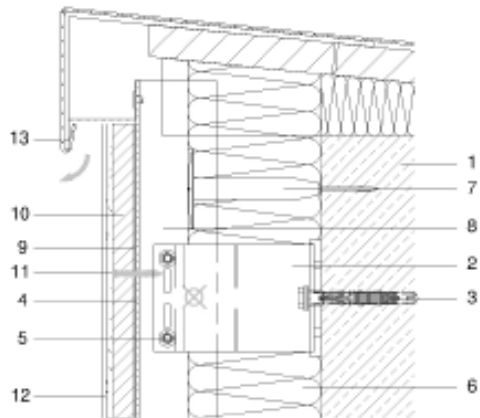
Detalhe construtivo de corte de cobertura [78].
